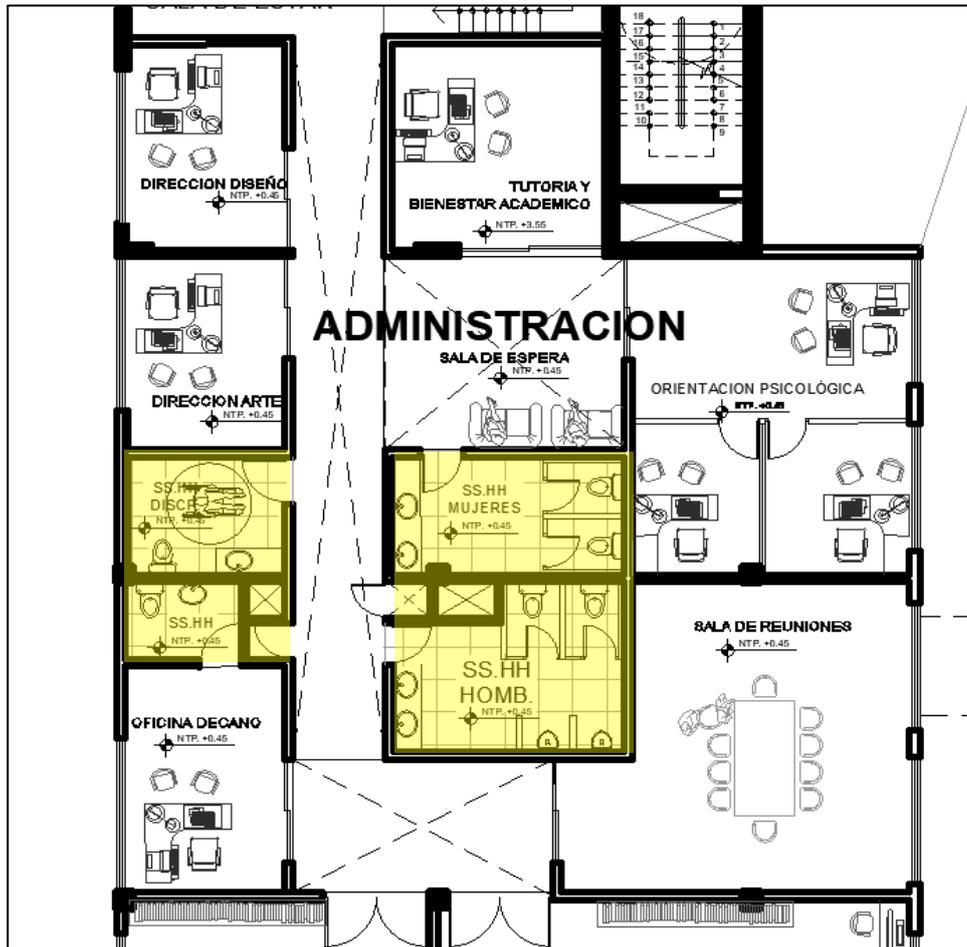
Planta segundo nivel del proyecto-administración. FUENTE: Elaboración propia.
